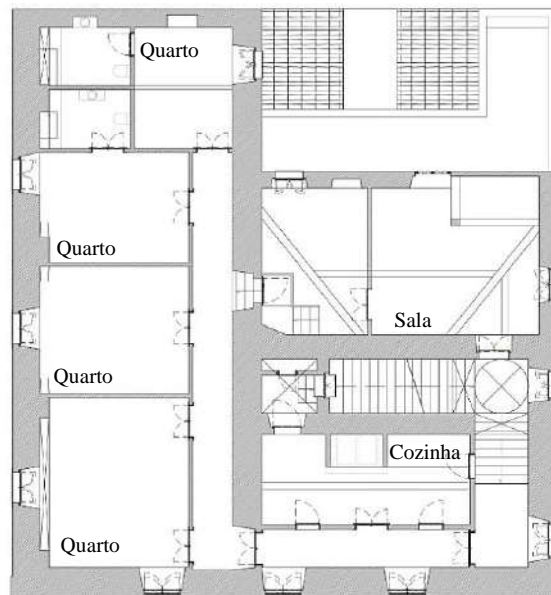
Planta primeiro piso Casa do Mirante - Existente
